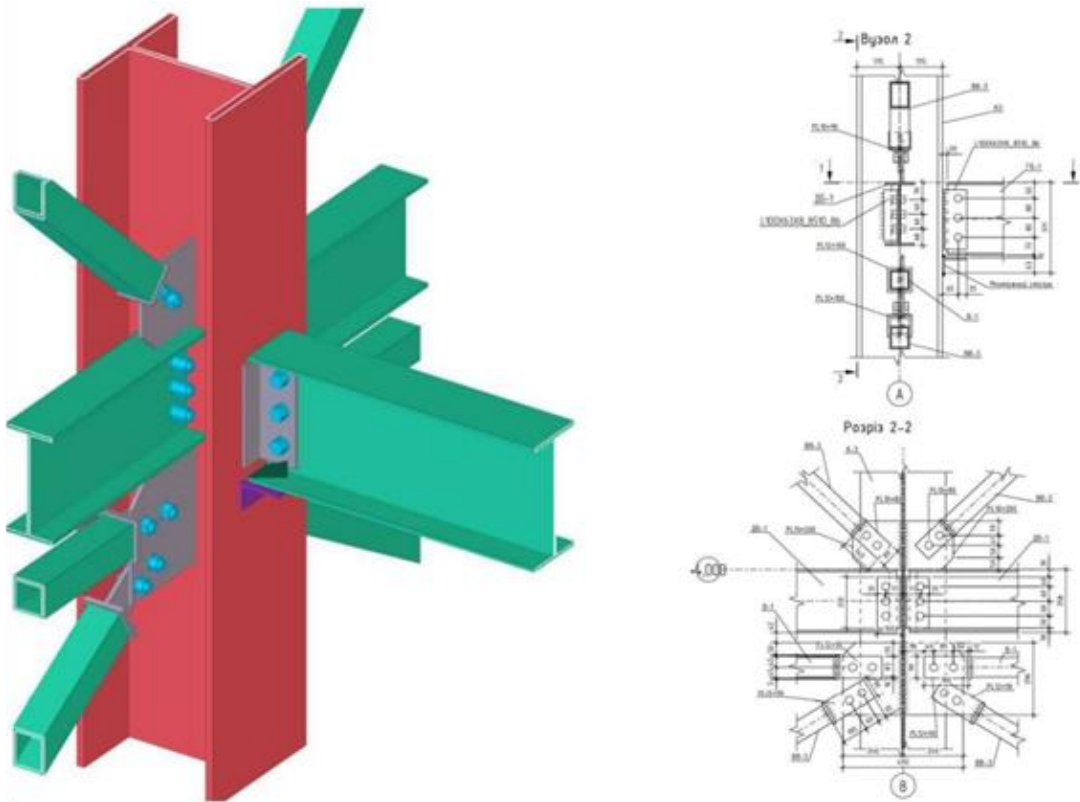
Вузол примикання головних балок до колони в ПК Tekla Structures
